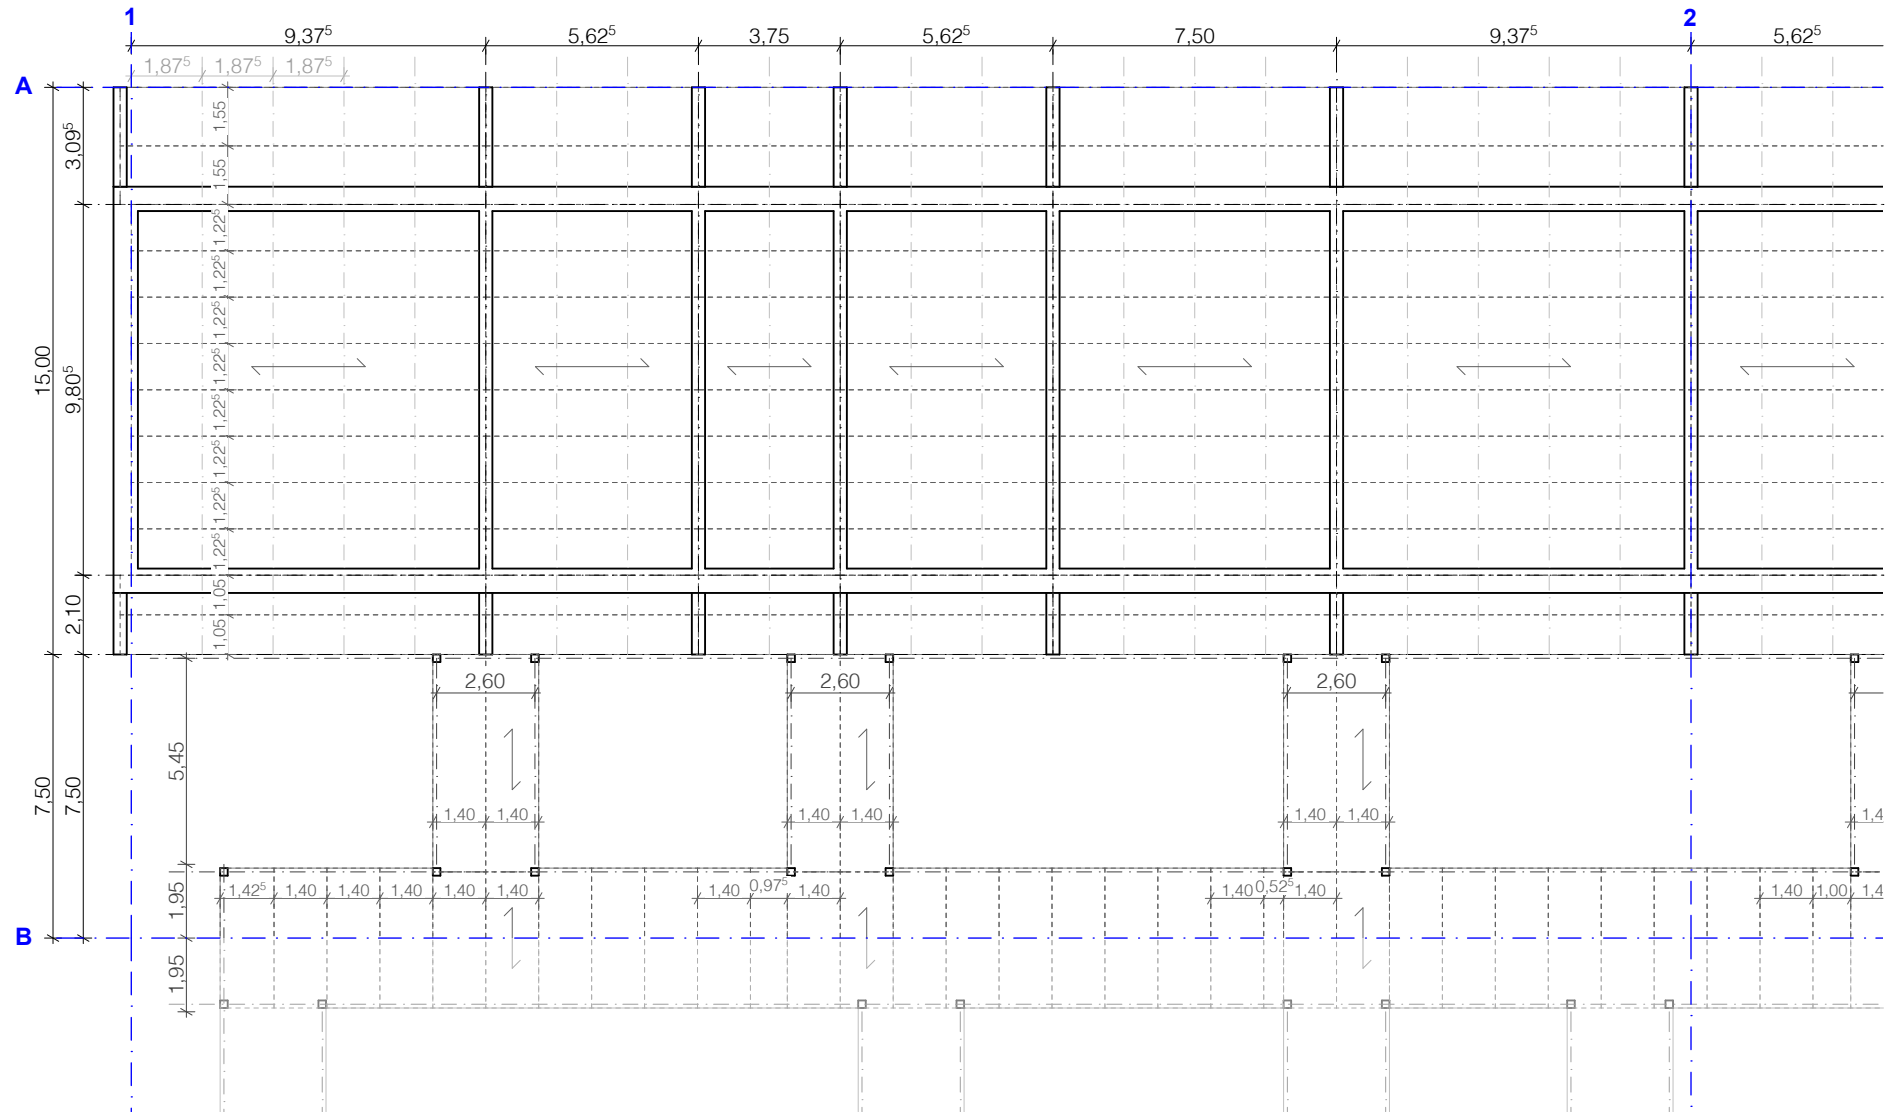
Tragwerksplan Ausschnitt I | M 1.200
